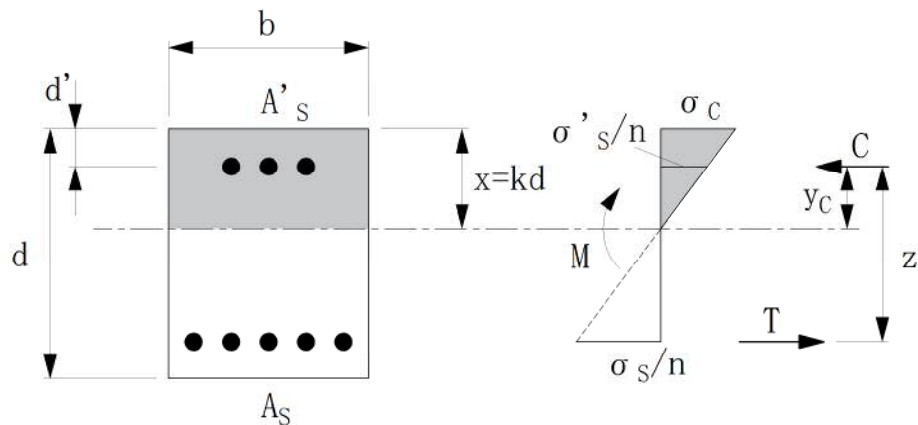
2軸複鉄筋断面の鉄筋コンクリート断面
